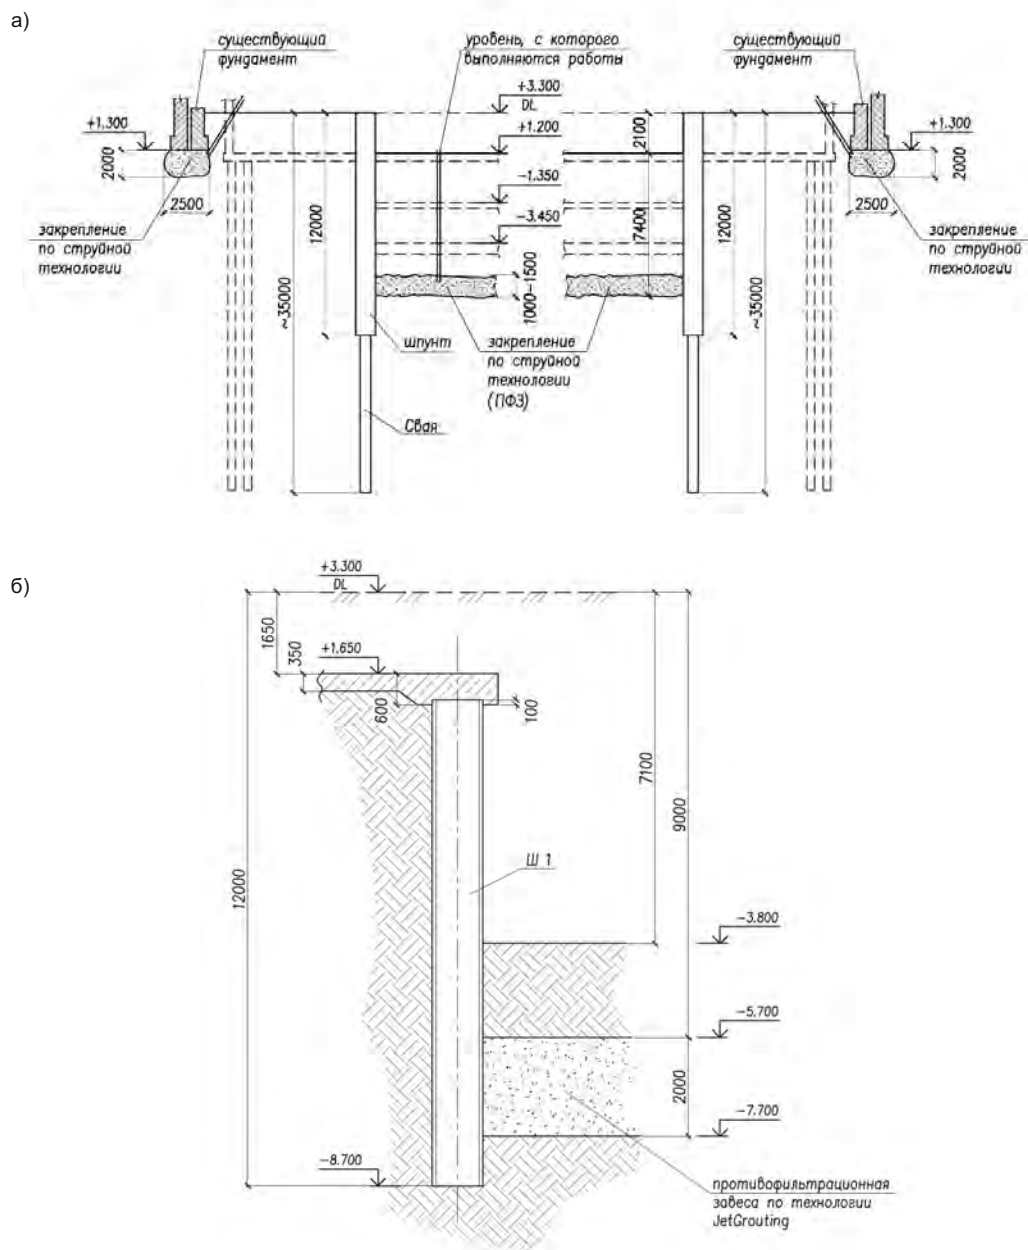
Схема устройства котлована «парк-сейфа»: а — поперечный разрез котлована; б — деталь
